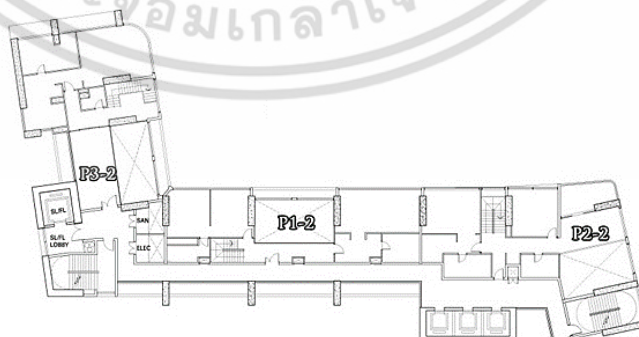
ผังโครงการ Menam Residences ชั้น 11
